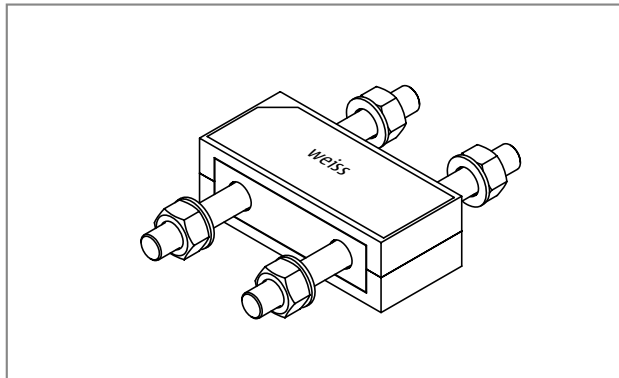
Schöck Isokorb® T Typ S-N-D22: Isometrie; Kennfarbe T Typ S-N: weiss
